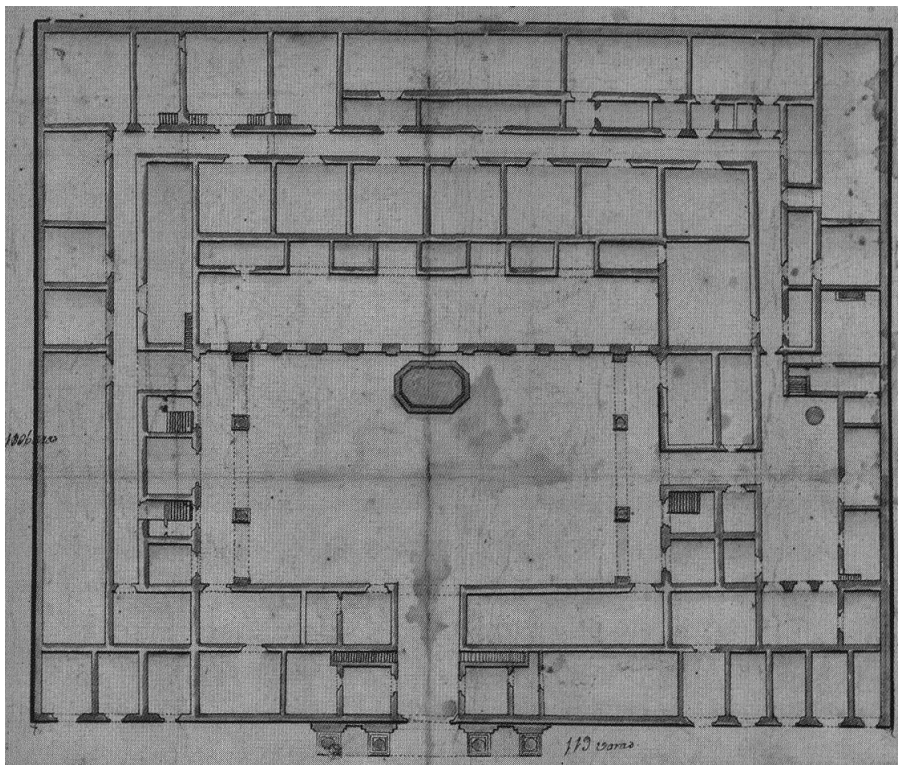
Plano de 1747, publicado por Luis Javier Cuesta Hernández.²²
